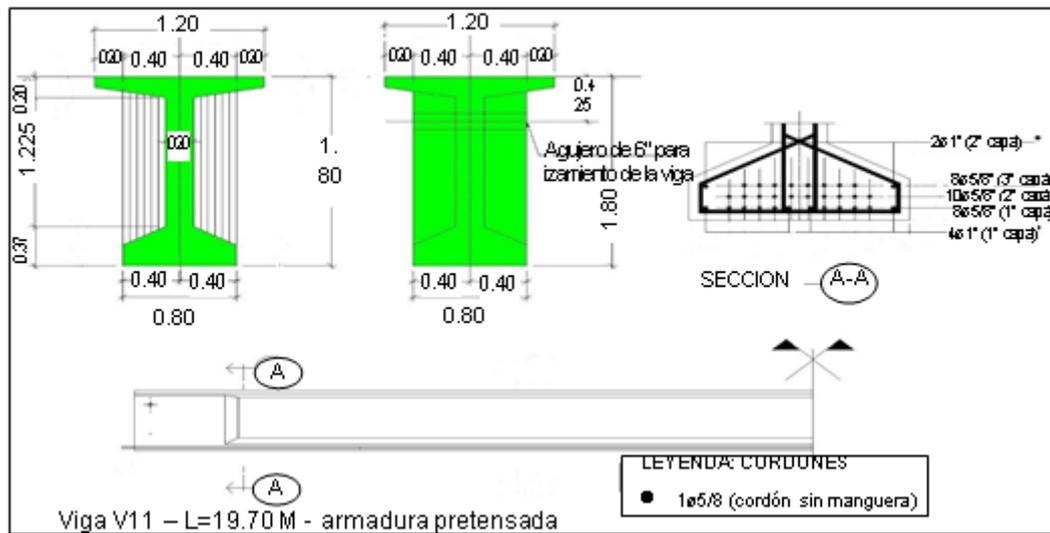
Geometría típica para viga prefabricada H=1.80m
